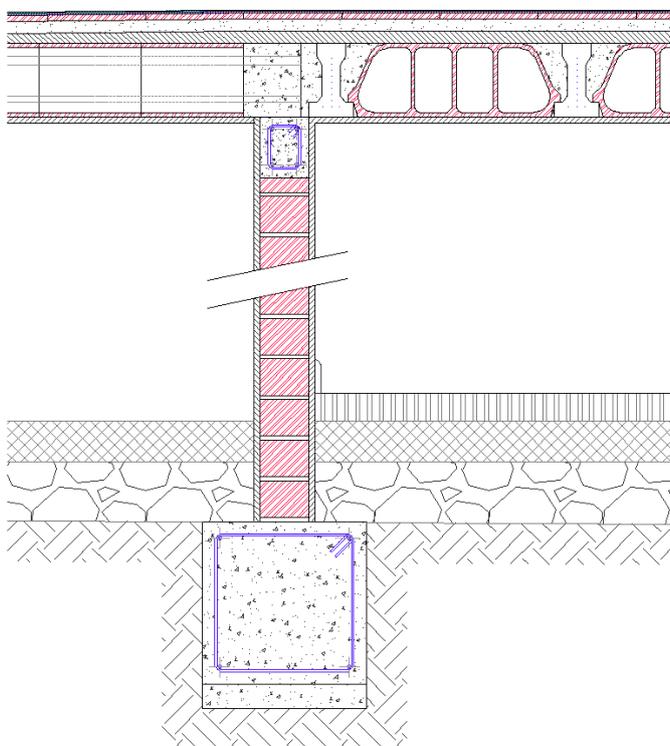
Detalle constructivo. Fuente: Elaboración propia.
